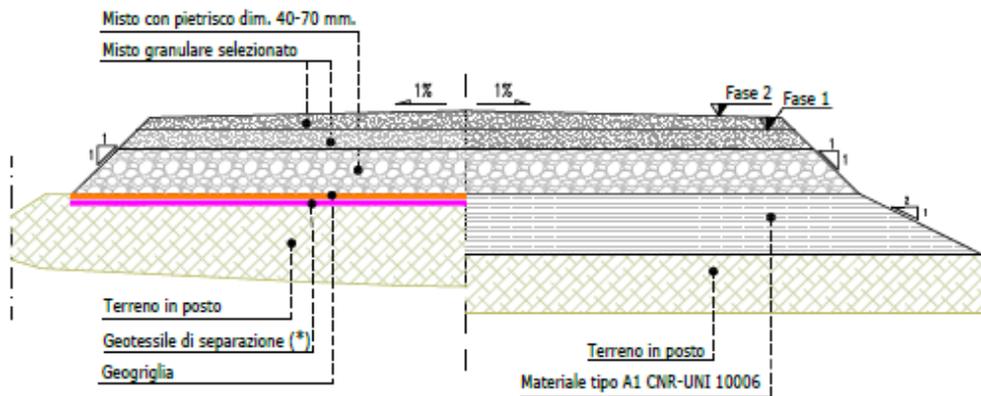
Sezione stradale tratti in rilevati ( $p < 13\%$ )
